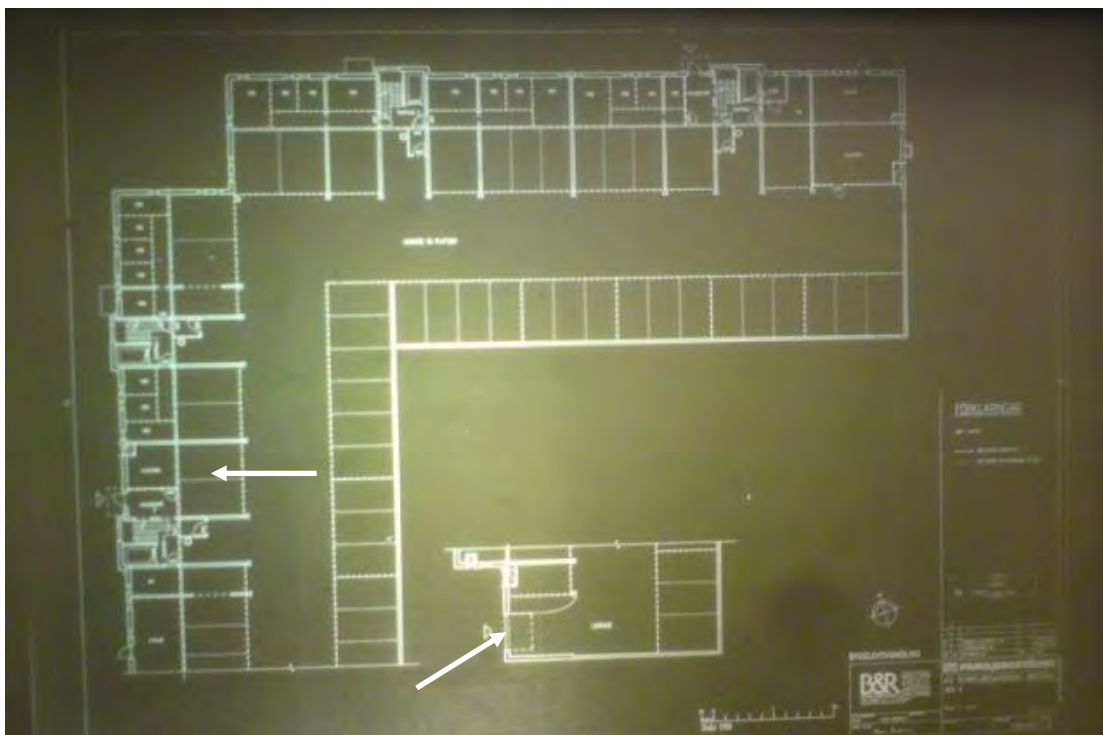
Planritning över det övre garage, där den nedre pilen visar garageporten och den övre var det brann.
